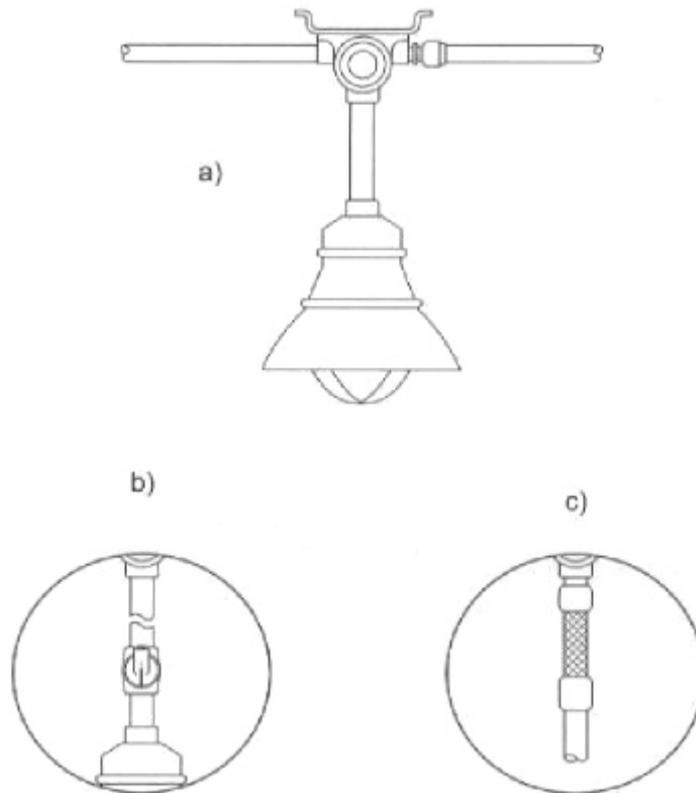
Tipici di collegamento tra scatola di infilaggio ed apparecchio di illuminazione "d"
